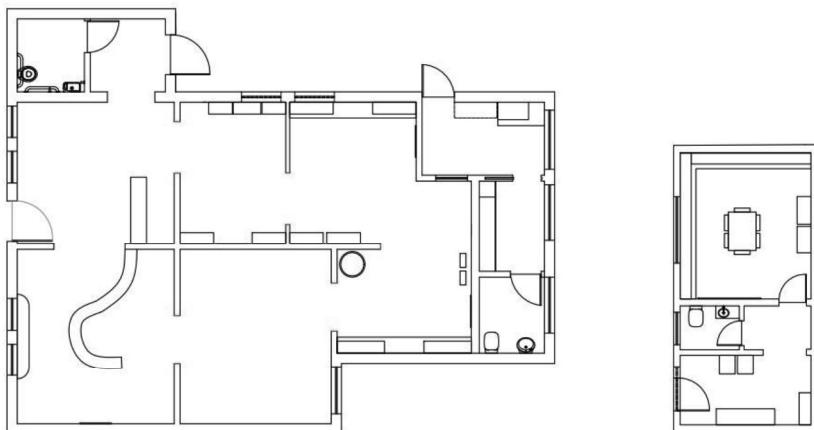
Planta em "AutoCAD" com primeira tentativa de aplicar o equipamento ao espaço
